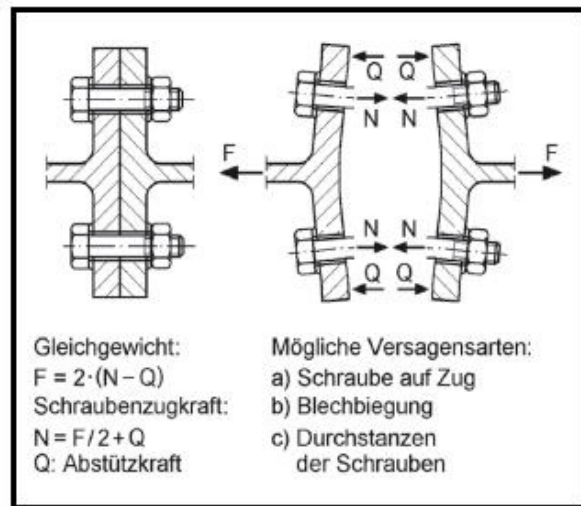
Versagensarten Zugbeanspruchter Schrauben
